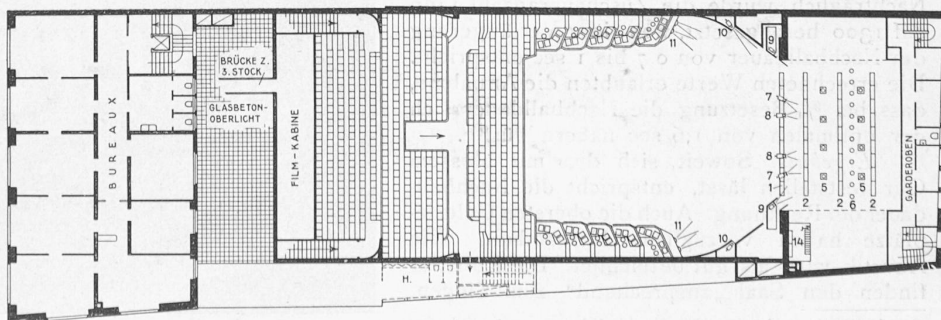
Grundriss vom 2. Geschoss: Galerie, Balkon und Logen; Bühnenbeleuchtung (Legende vergl. Abb. 14).
